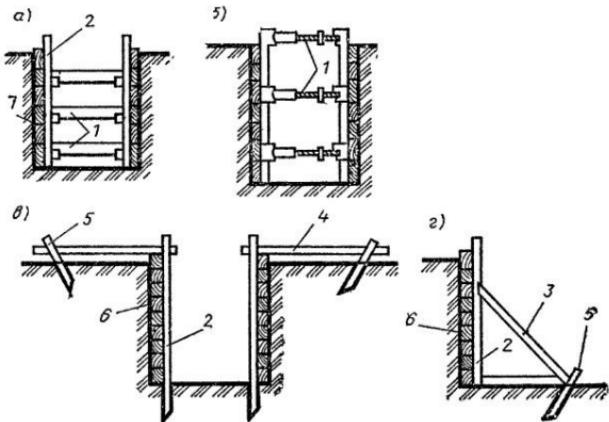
Поперечный разрез дощатых щитов, закрепляющих стенки траншей и откосов
